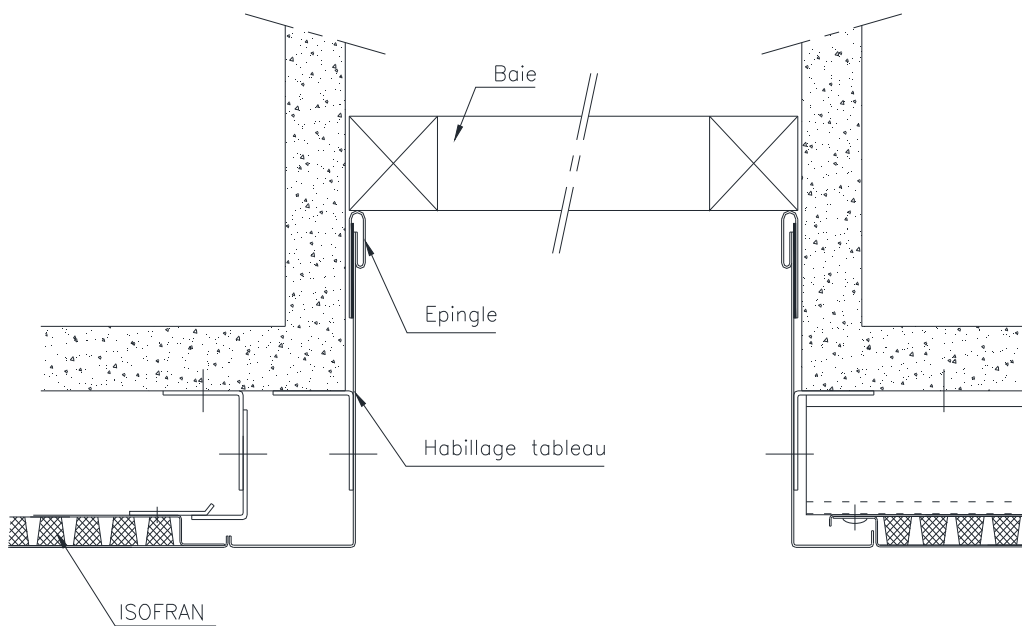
Panneau ISOFRAN à bords pliés Pose verticale - tableau de baie
